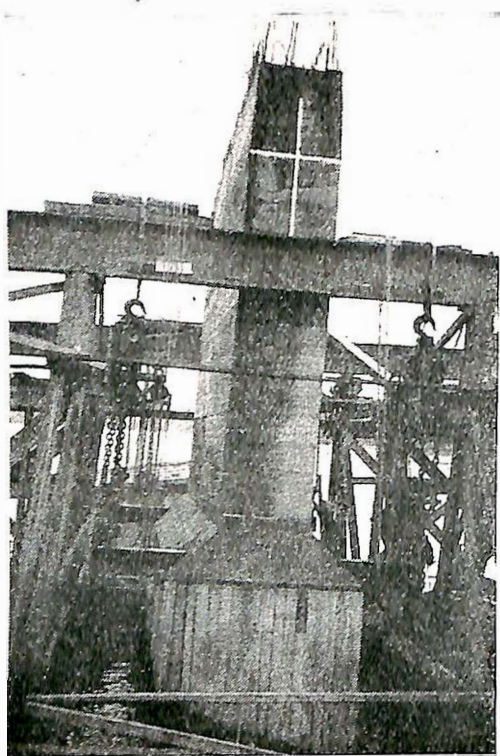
Sunkasse av armert betong, opphengd mellom to pongtongar.
